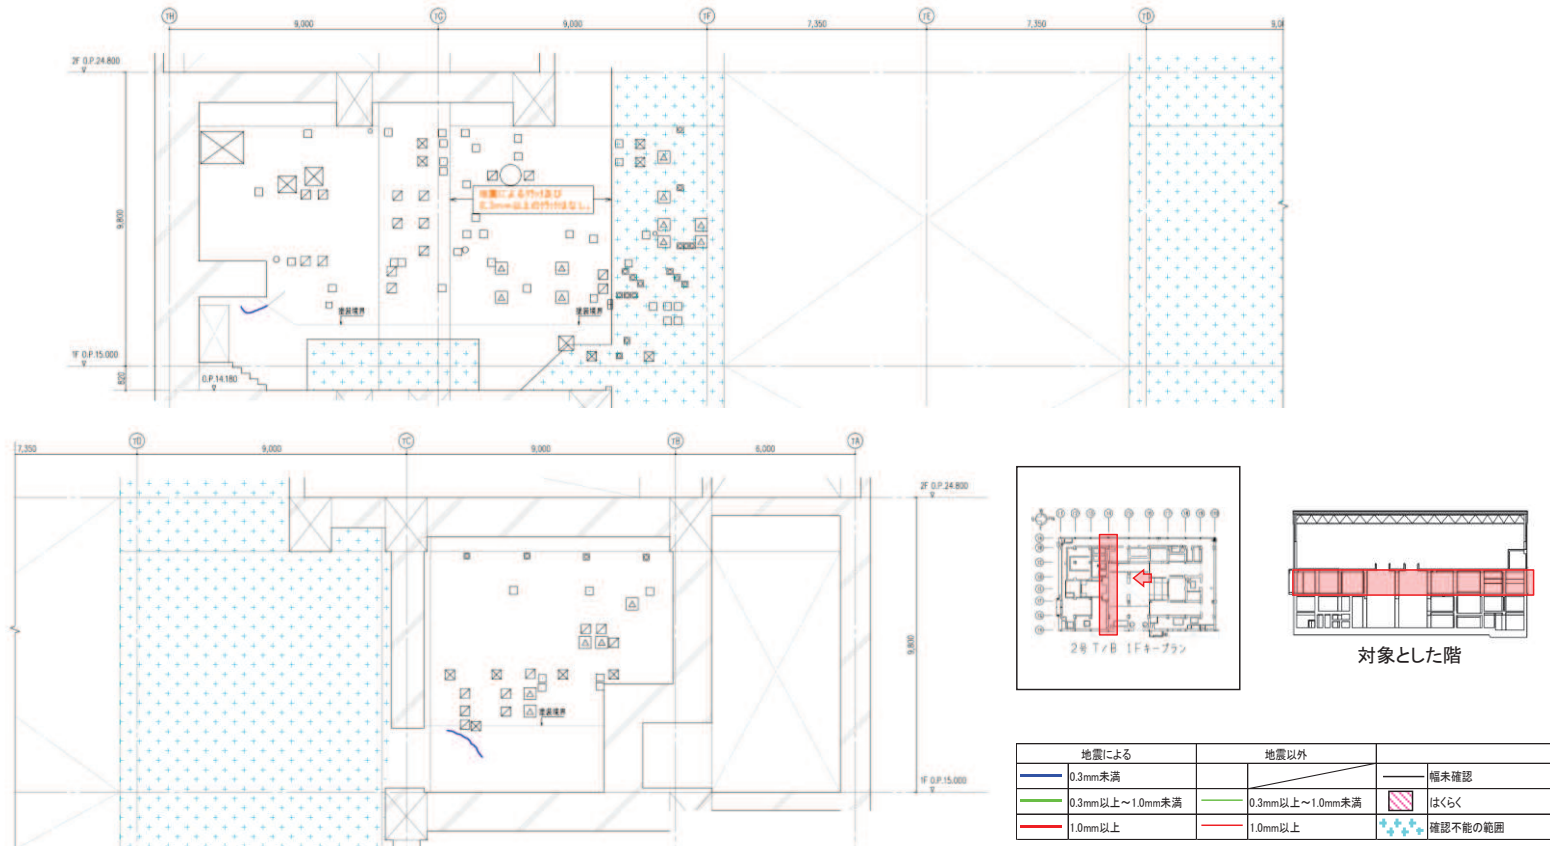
タービン建屋のひび割れ分布 耐震壁 (36) 1階 T4 通り
